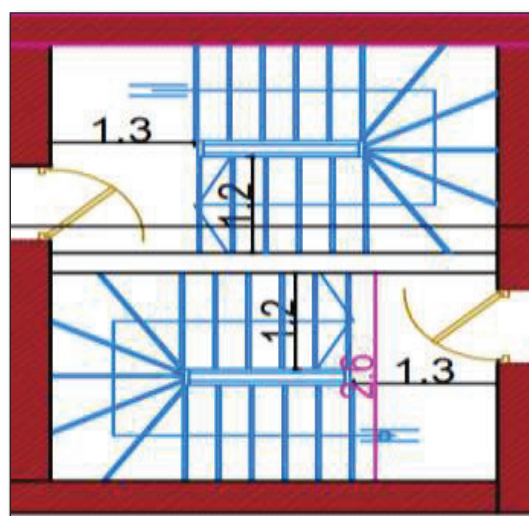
Vue en plan d'escalier RDC-15^{ème} étage.
